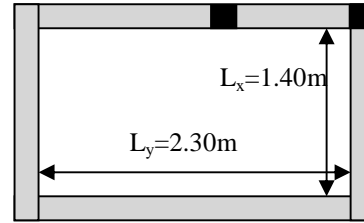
Schéma d'une dalle sur quatre appuis.
